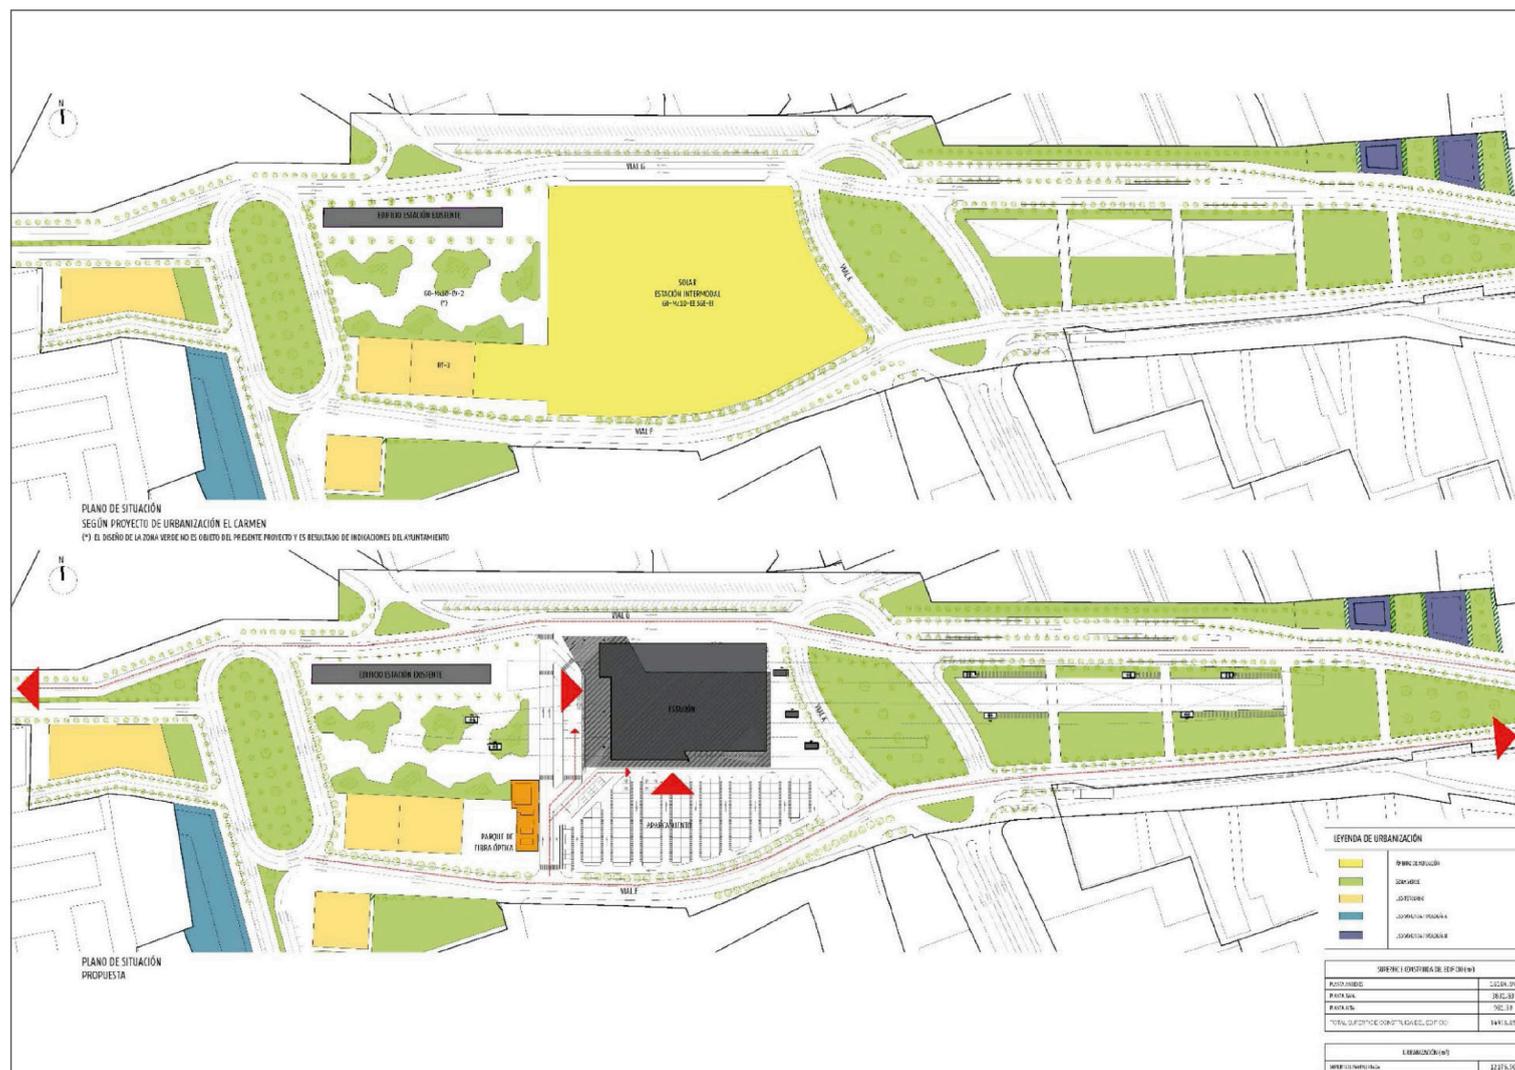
Planeamiento estación. (Fuente: Proyectos de construcción RAF Murcia. Soterramiento de Estación y Barriomar y Nonduermas”, noviembre 2018, ADIF)
